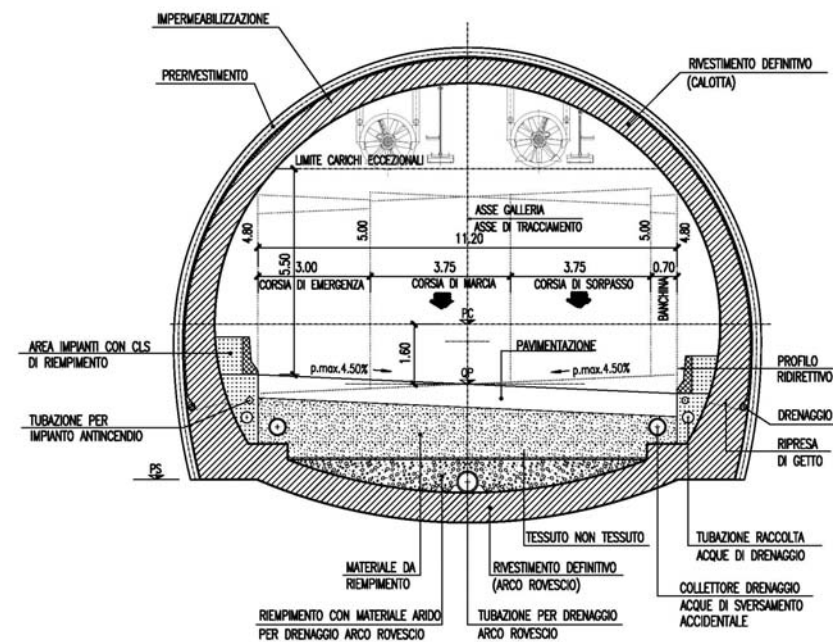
Sezione tipo in galleria naturale con scavo tradizionale
